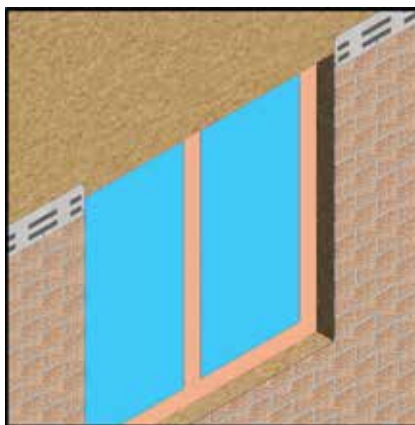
Монтаж фасадной плитки вокруг оконного проёма.
